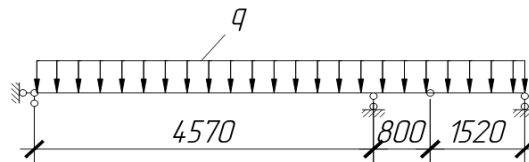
Расчетная схема стропильной ноги
